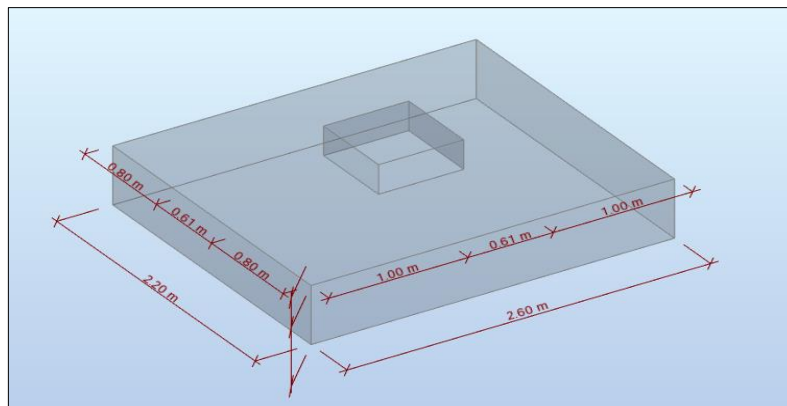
Modelo preliminar tridimensional de la zapata C01-01.
